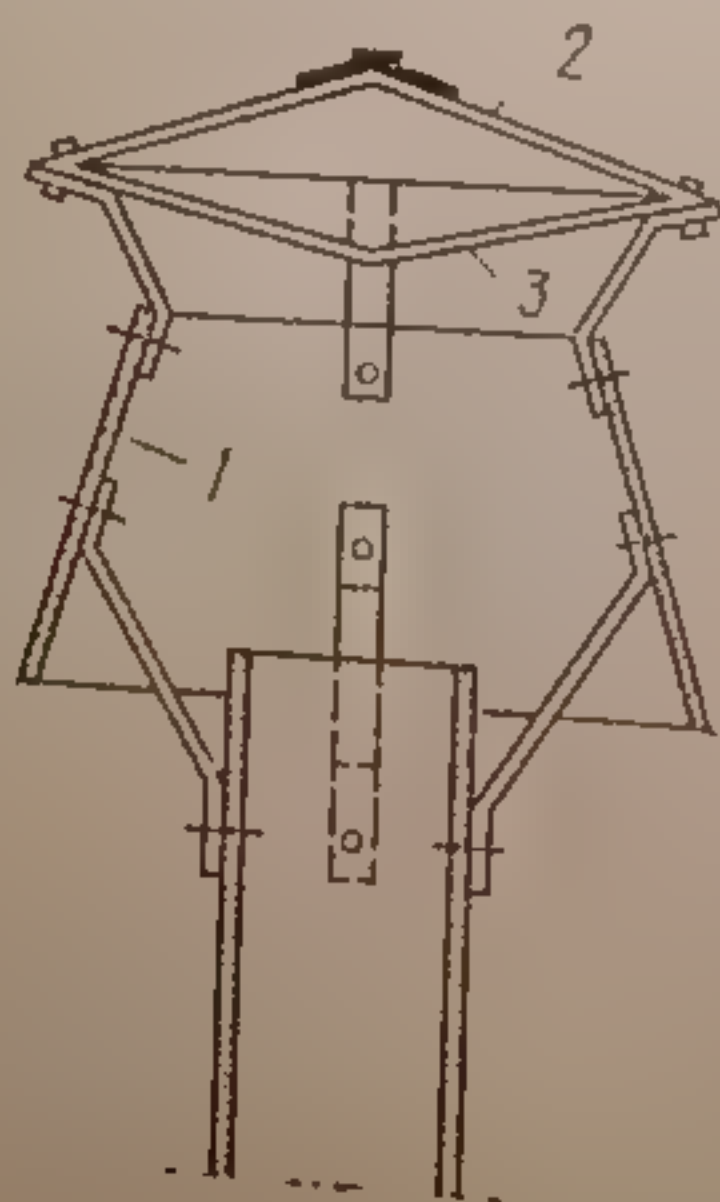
Дефлектор конструкции Григоровича: 1 — диффузор; 2 — колпак; 3 — обратный конус
